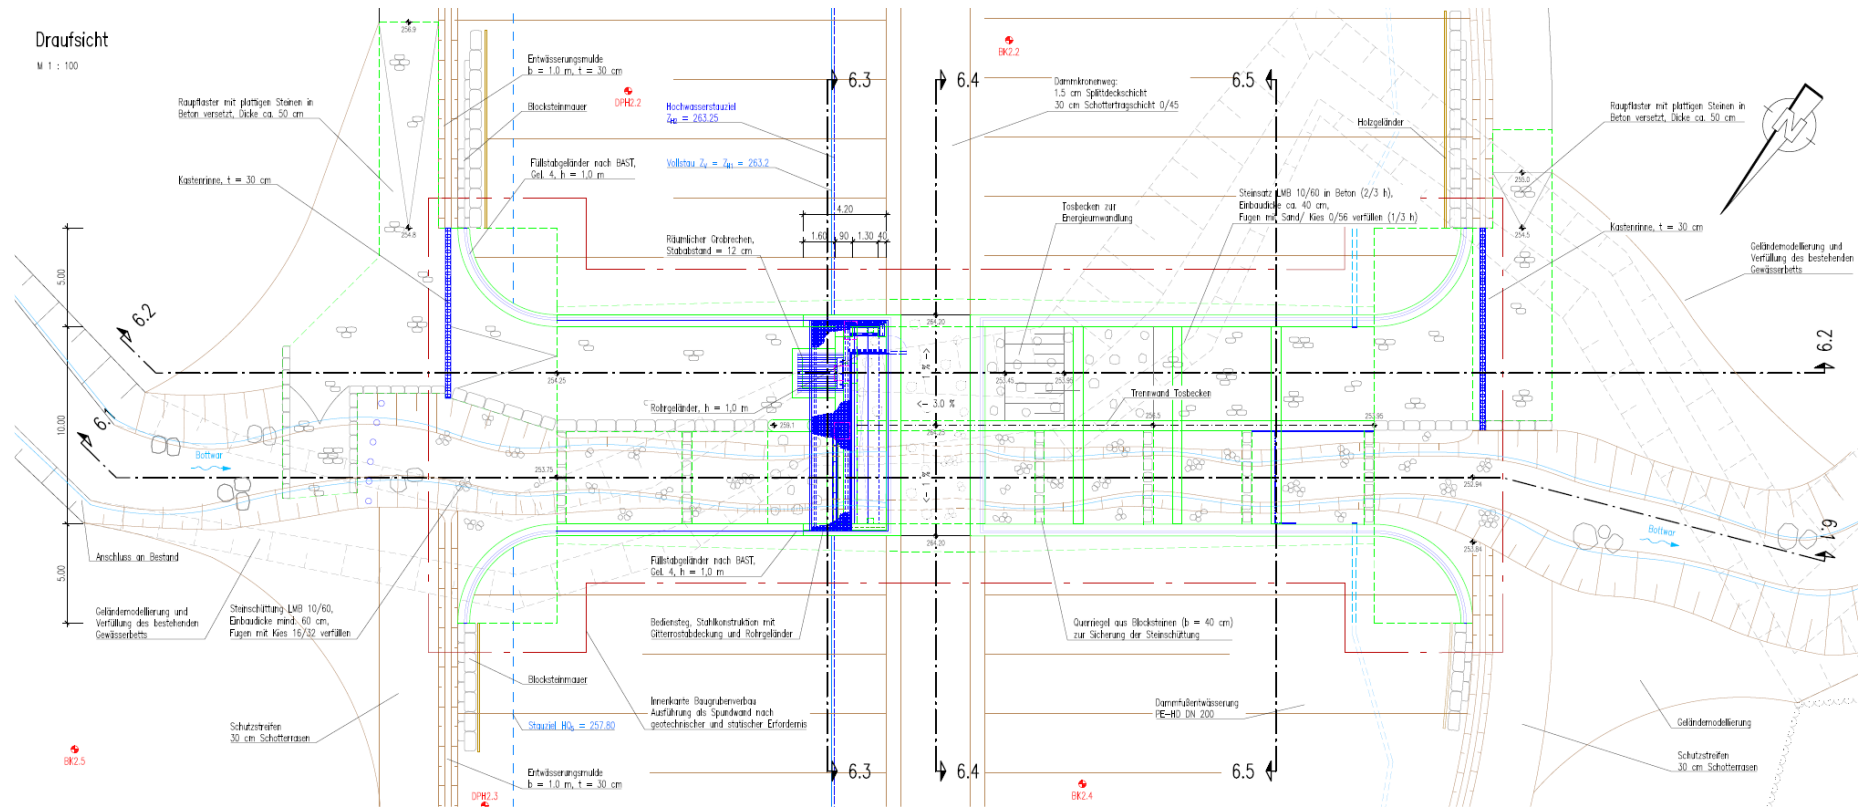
Unmaßstäblicher Grundriss des Auslassbauwerkes (Detaillierter Darstellung siehe Unterlage Lageplan siehe Unterlagen Teil B Plan 006-1, INGENIEURBÜRO WINKLER UND PARTNER, 2019/2020)
